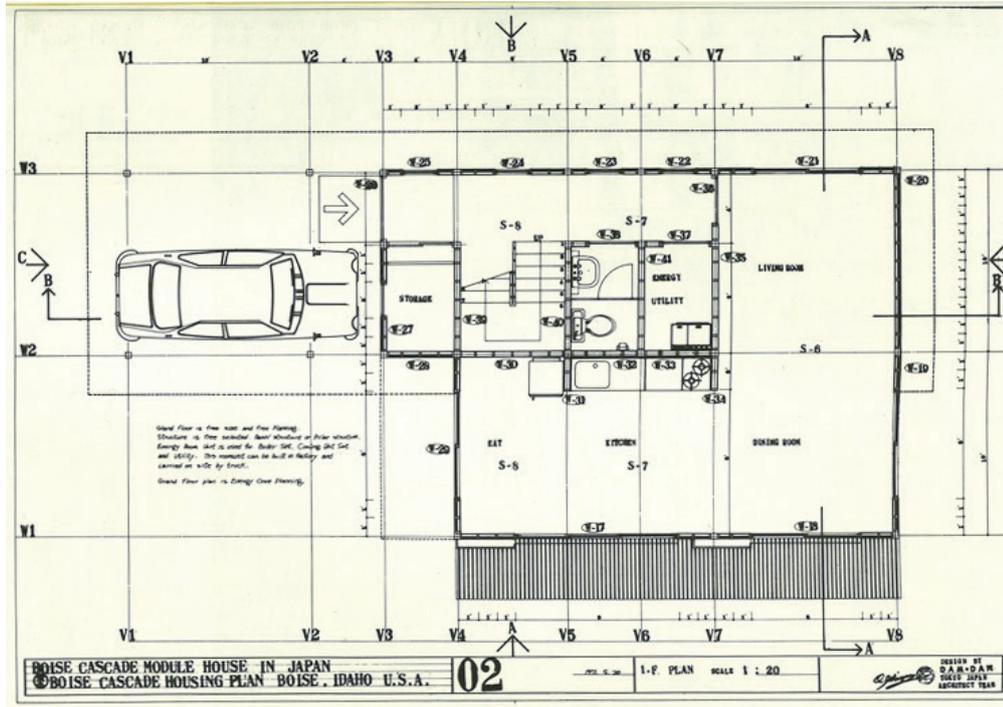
Osamu Ishiyama. Plano enviado a Estados Unidos para la construcción de la primera vivienda enviada en contenedor. Fuente: *Shinkenchiku*.
